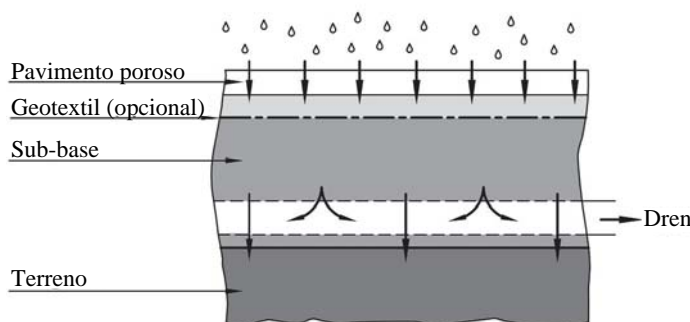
Sección tipo de un pavimento poroso (Woods-Ballard et al., 2007).
